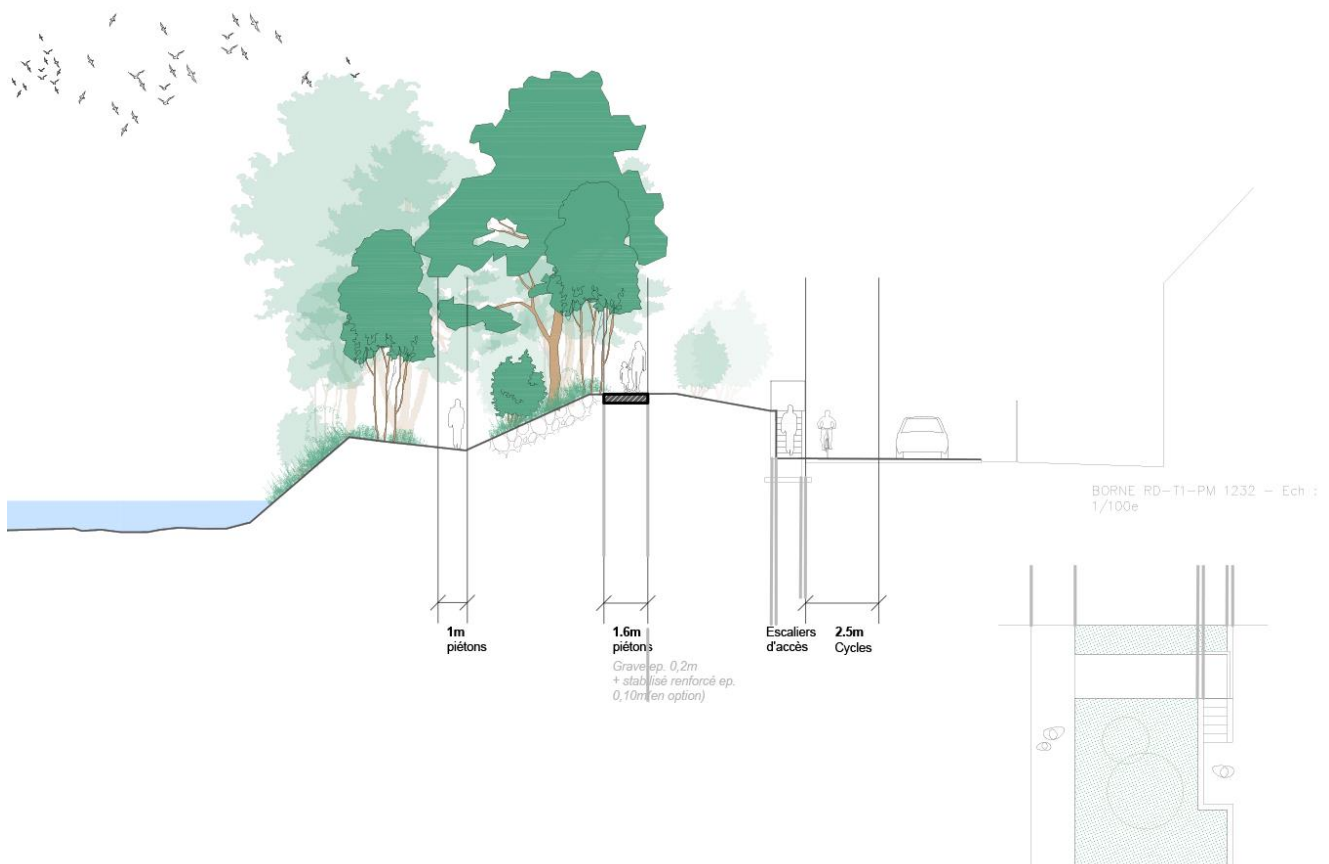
Profil type RD-T1 et vue en plan des escaliers d'accès
